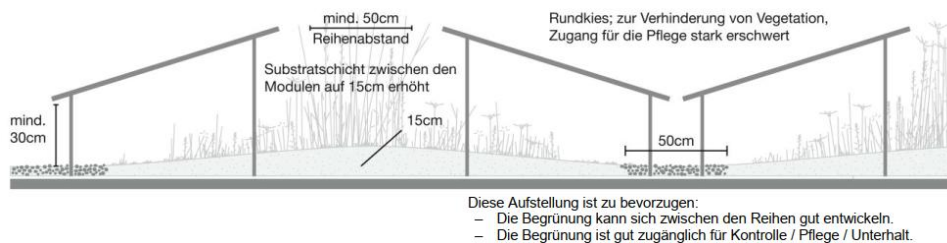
Beispiel Schnitt Ansicht Dachaufbau PVA (rein symbolisch, Modullageplan beachten)
